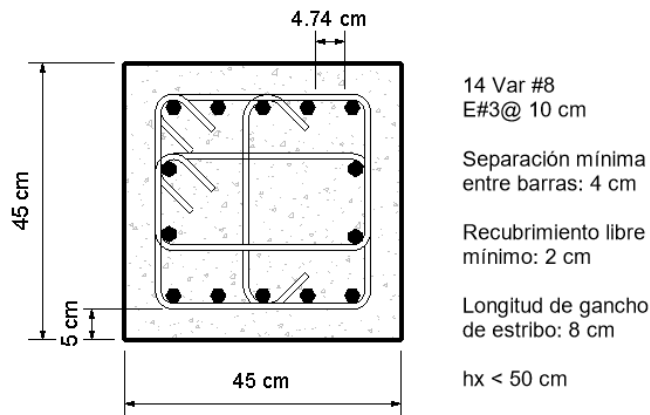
Croquis de armado columna de planta baja. Fuente: elaboración propia.
